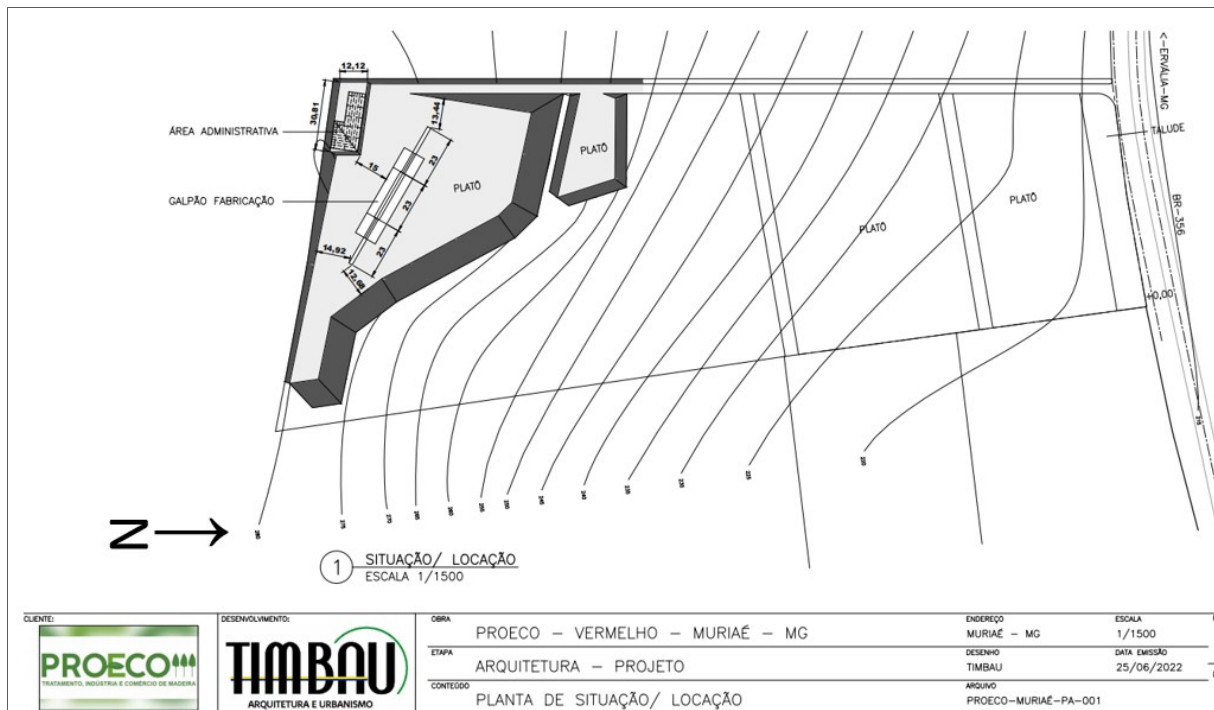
Ilustração da planta do Lay-Out planejado para o empreendimento, com destaque para as estruturas. (Fonte: adaptado RCA).
